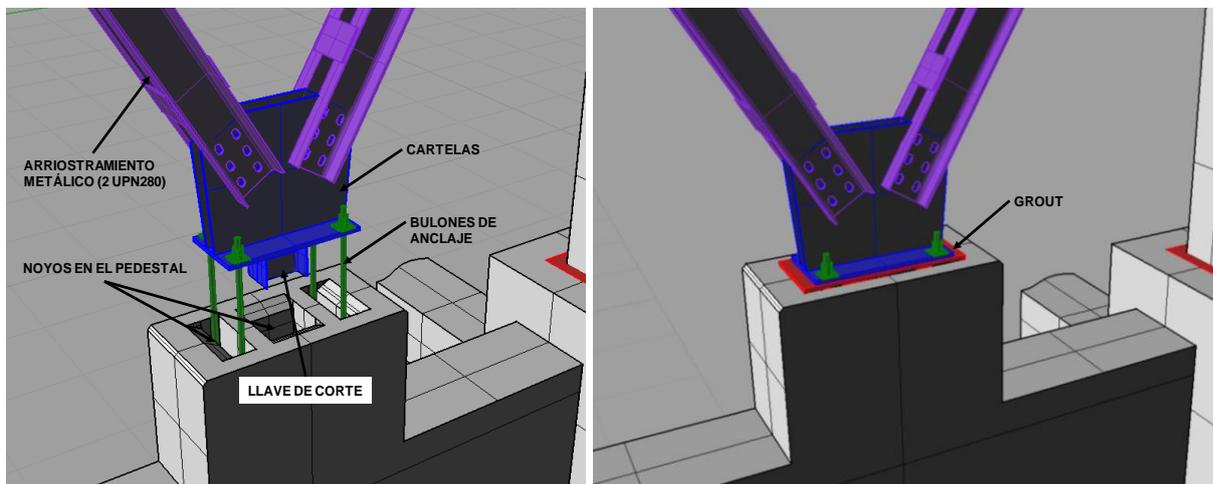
Esquema de conexión entre el arriostramiento y las fundaciones
